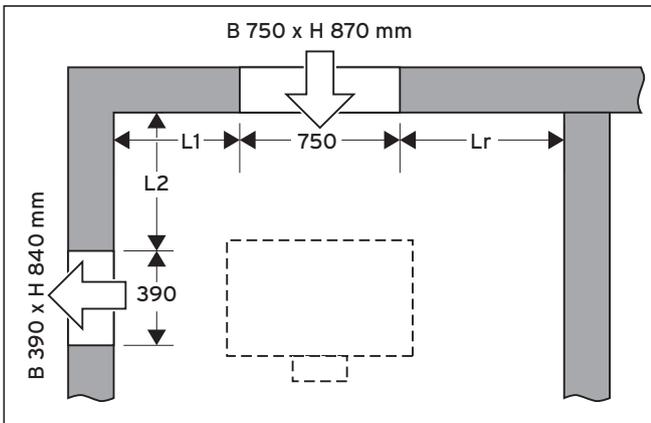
Hjørneinstallasjon, luftuttak til venstre
